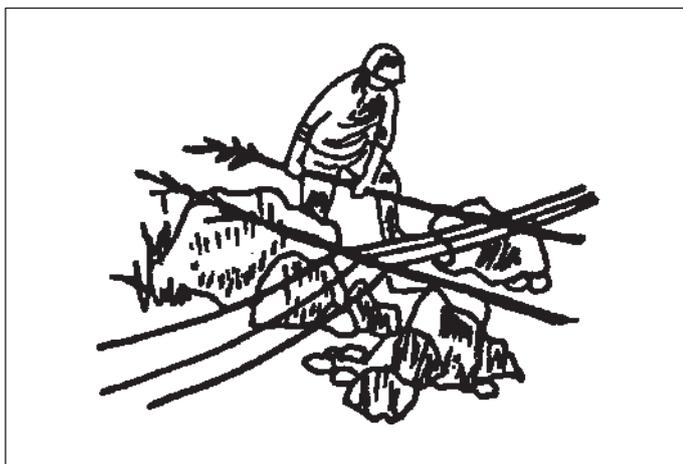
Прикрытие предметов, опасных с точки зрения повреждения проводов, расположенных на трассе раскатки проводов.
